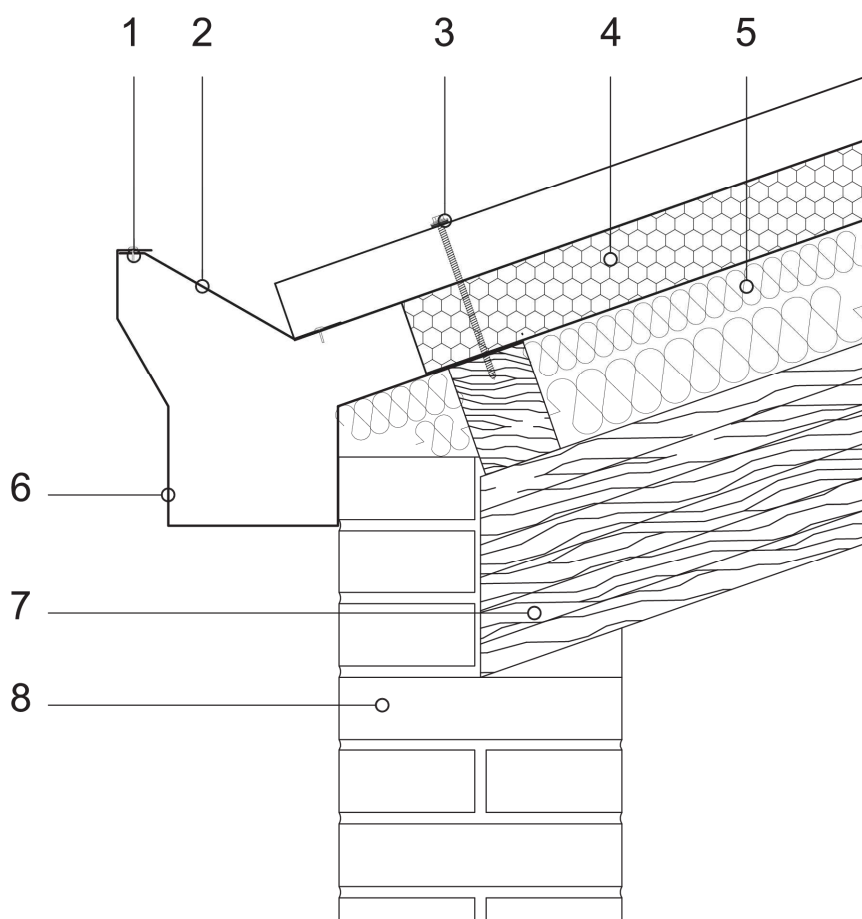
DETAIL COTE CHENEAU SUR UNE STRUCTURE TRADITIONNELLE
